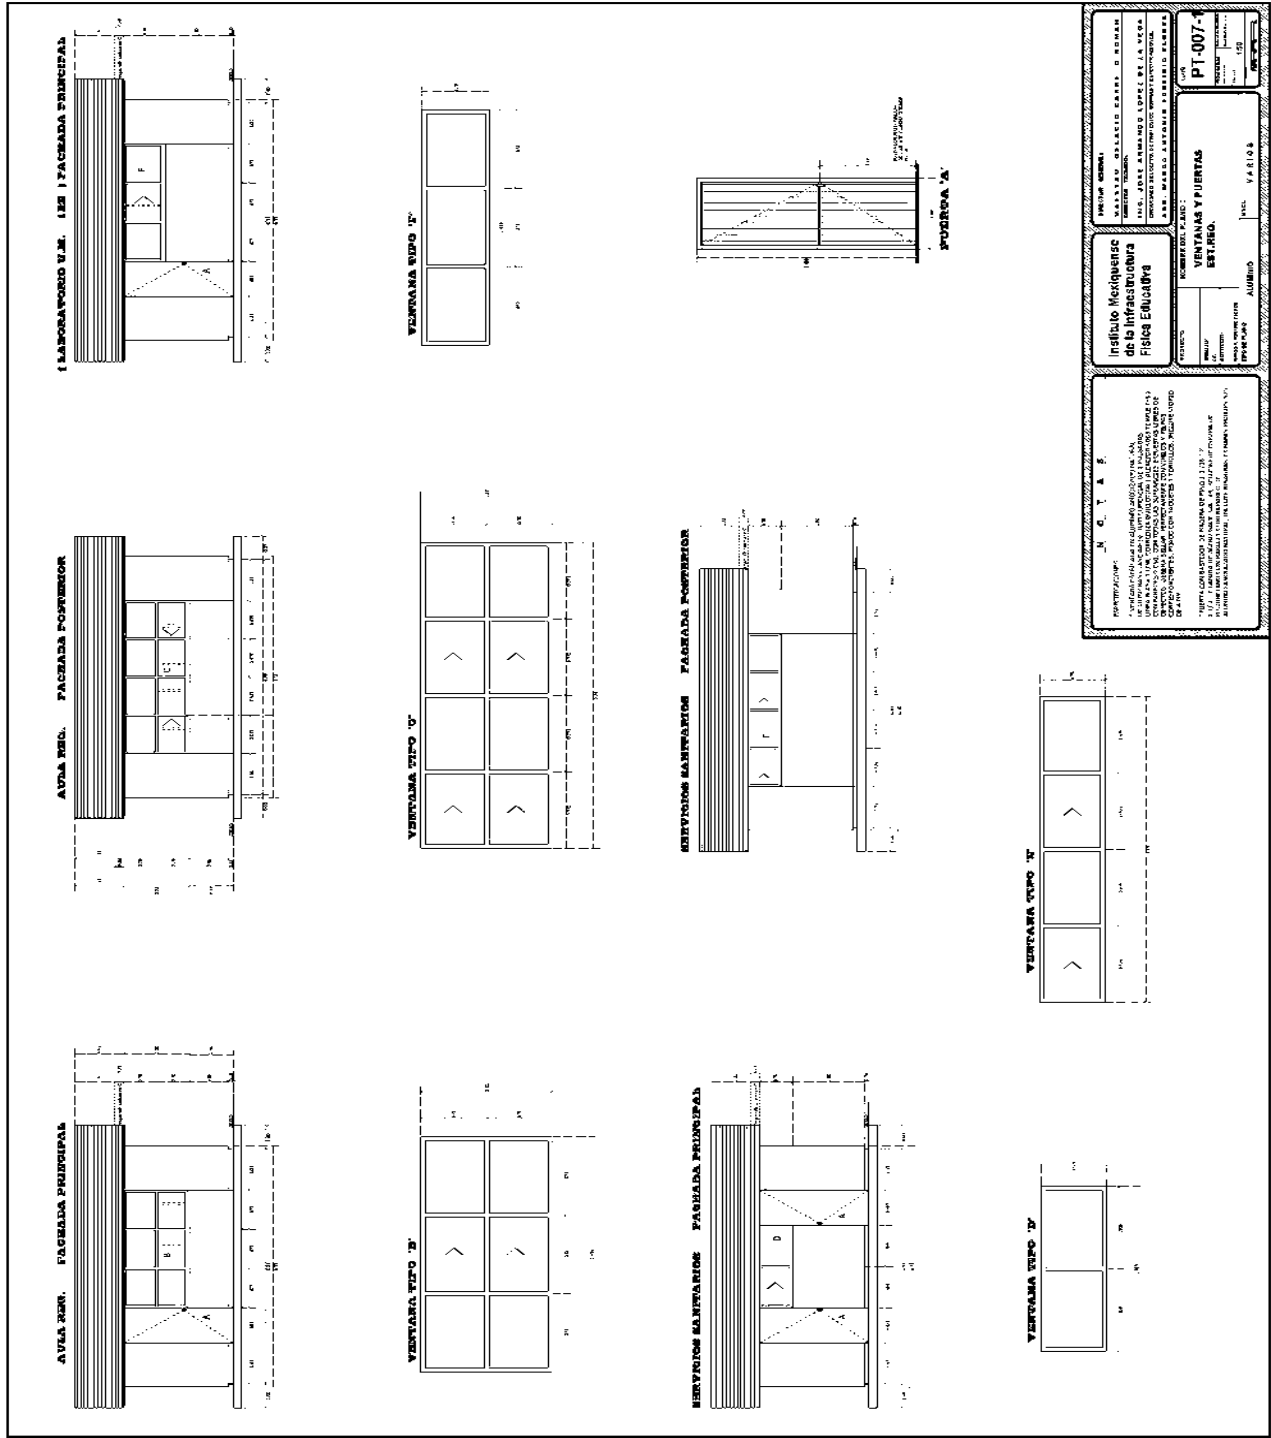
Detalle Plano de cancelería puertas y ventanas.
